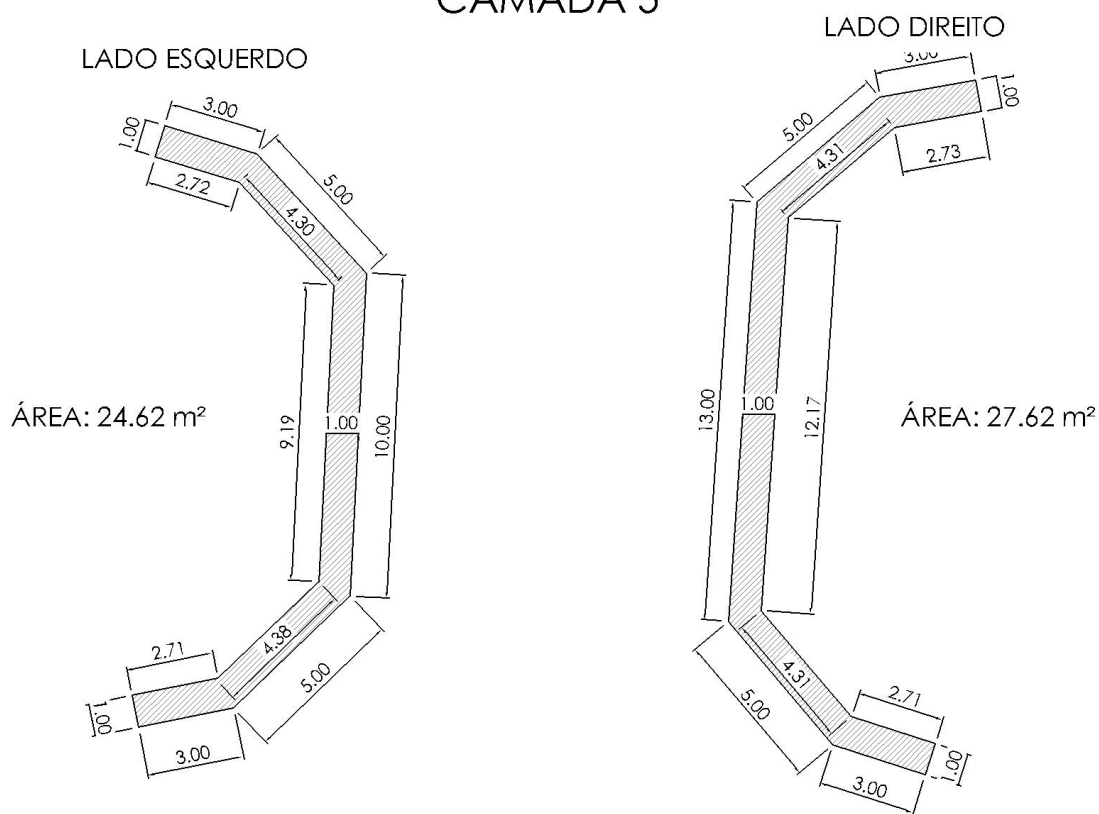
Módulo de gabões tipo caixa. Camada 5.
